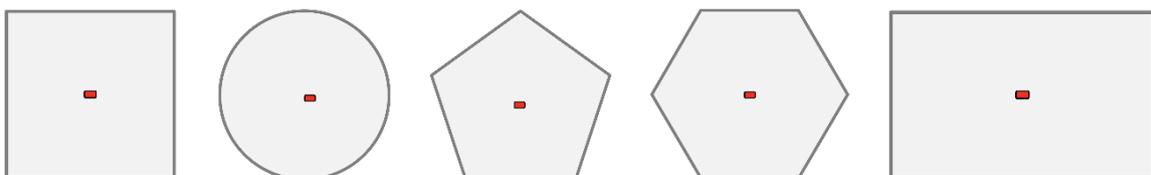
一般平面形狀建築，建議感測器平面配置說明圖
